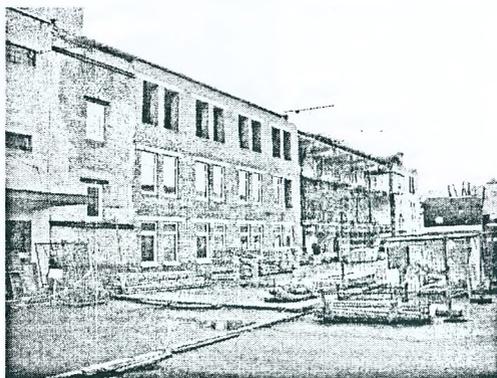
Вид здания АБК после выполнения кирпичной кладки первой захватки
